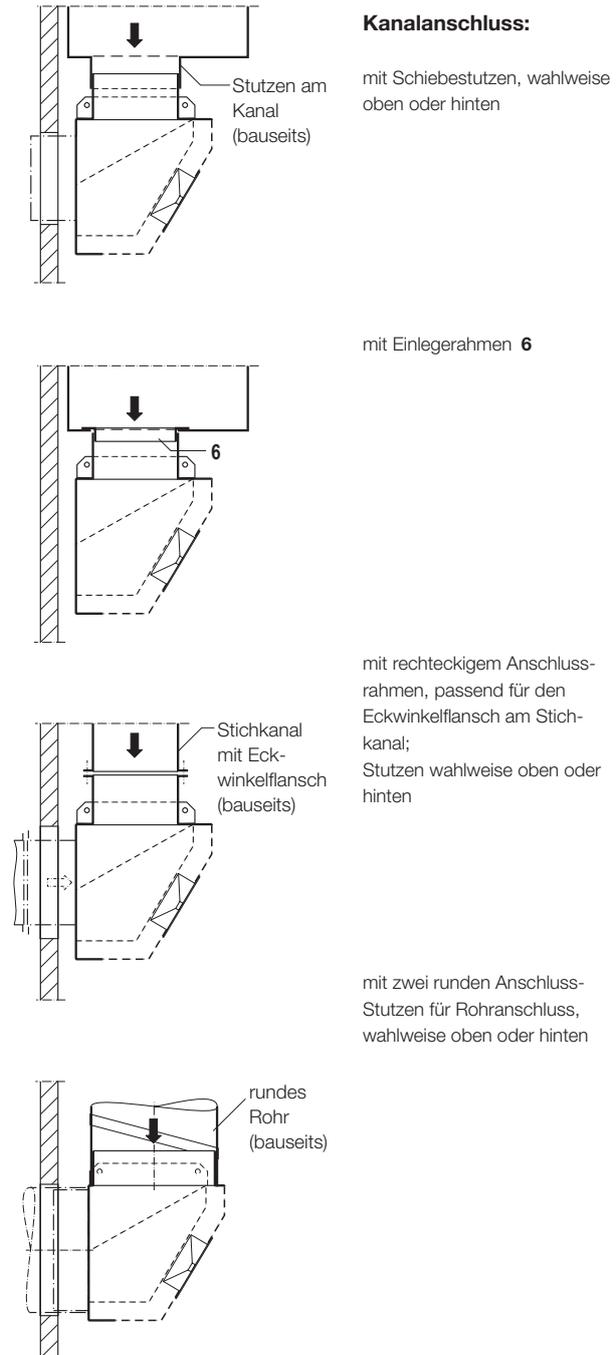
Trapezförmiger Verdrängungsauslass, Anordnung und Anschluss
